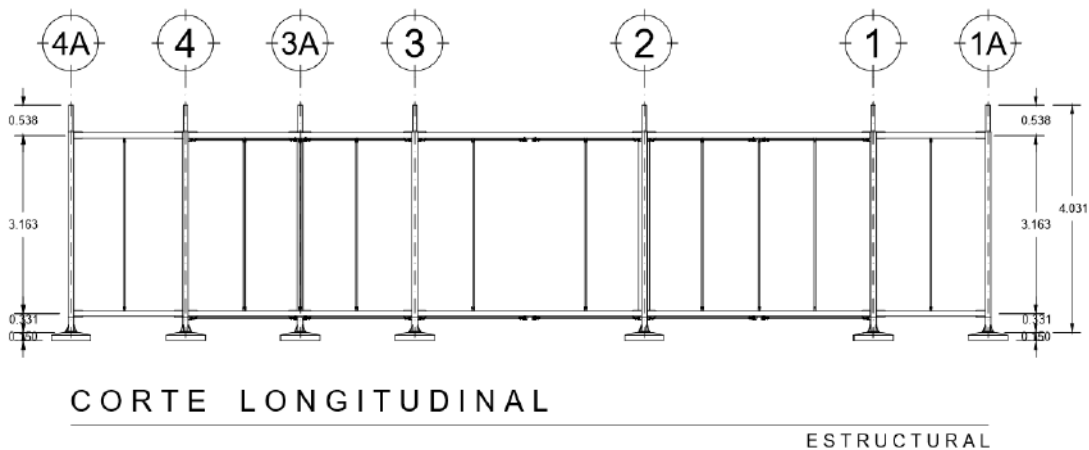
Corte longitudinal del modelo estructural (Dibujo hecho en AutoCAD 2016, por el autor).
